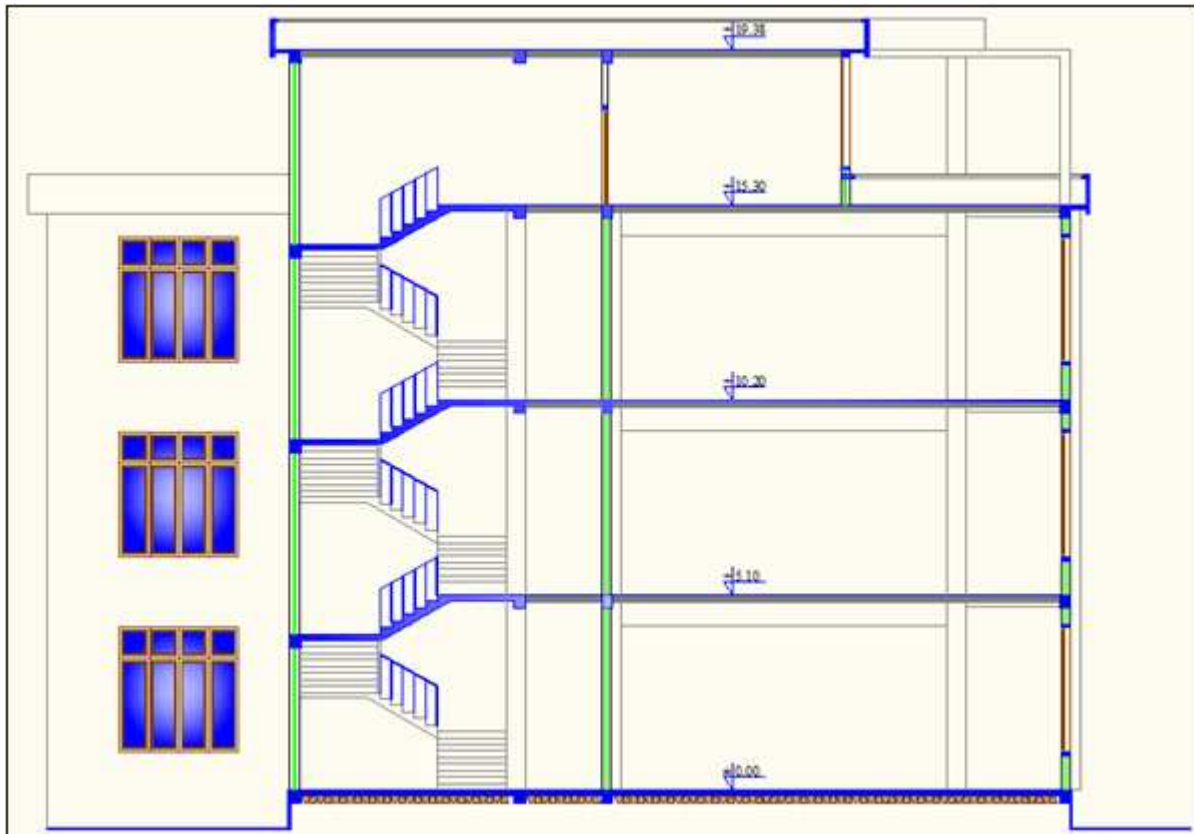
La coupe BB du bloc 1 (SAZA 2014)
